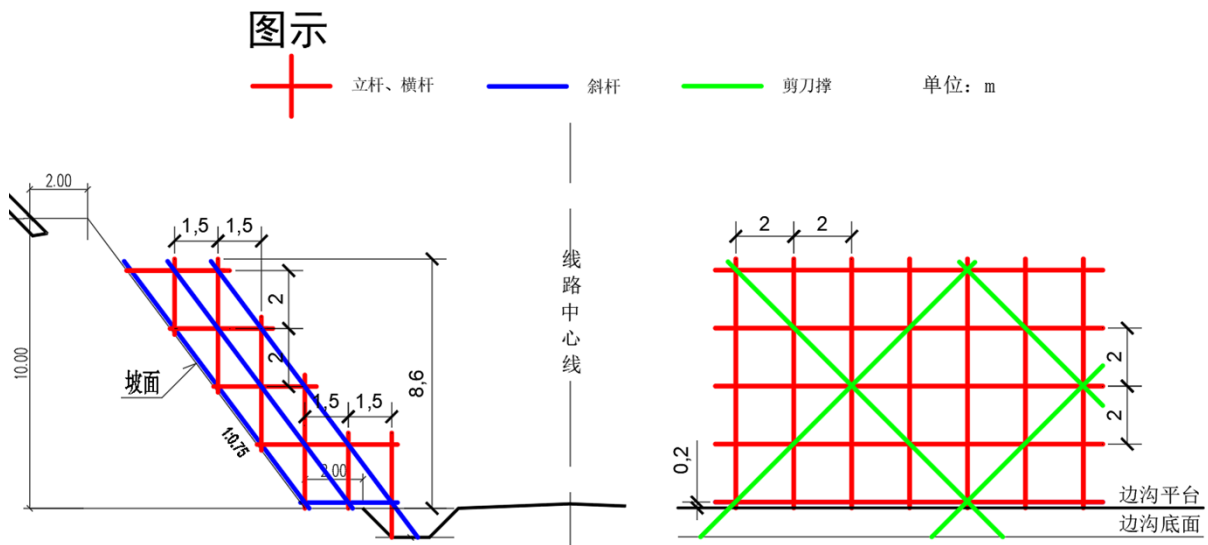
脚手架工作平台横向、纵向断面搭设图
